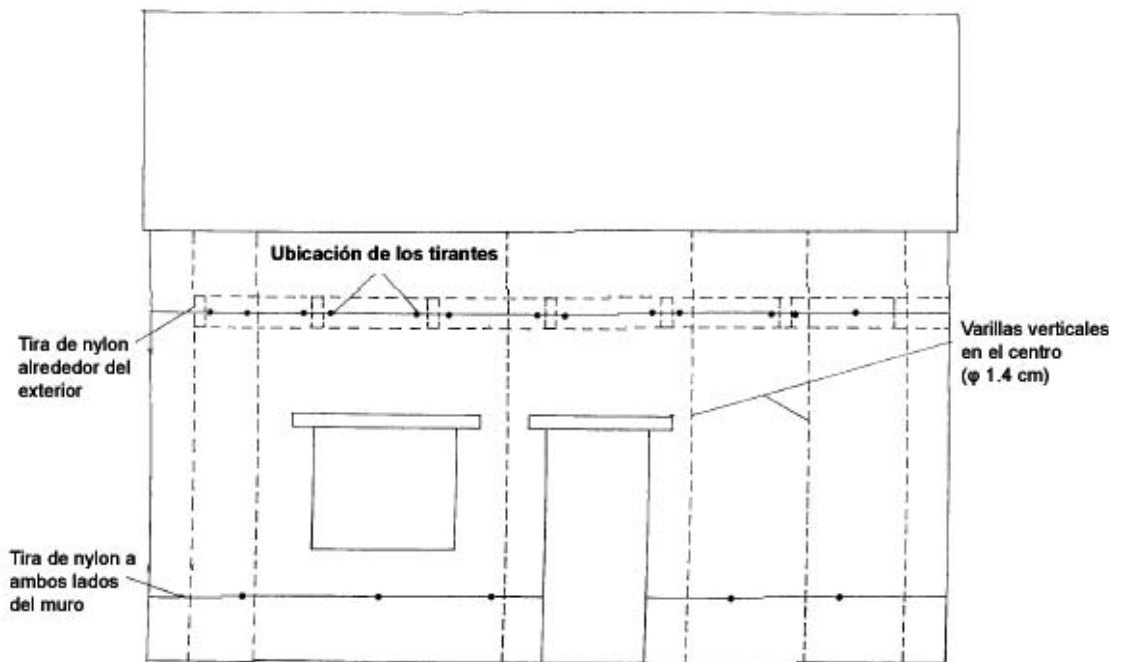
Elevación de Módulos Mostrando el Sistema de Refuerzo Aplicado al Muro Exterior (Tolles y otros, 2000)
